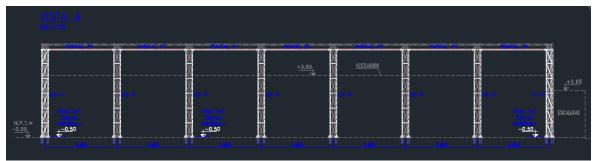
Imagen de proyecto de cubierta metálica para pileta – proyecto parque este
